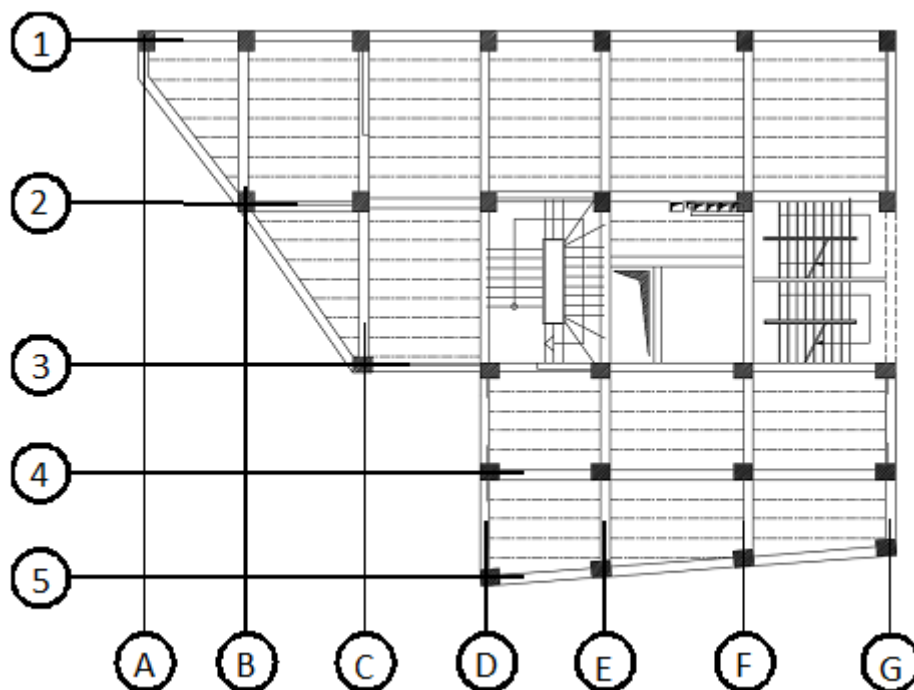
Disposition des poutrelles dans un plancher en corps creux
